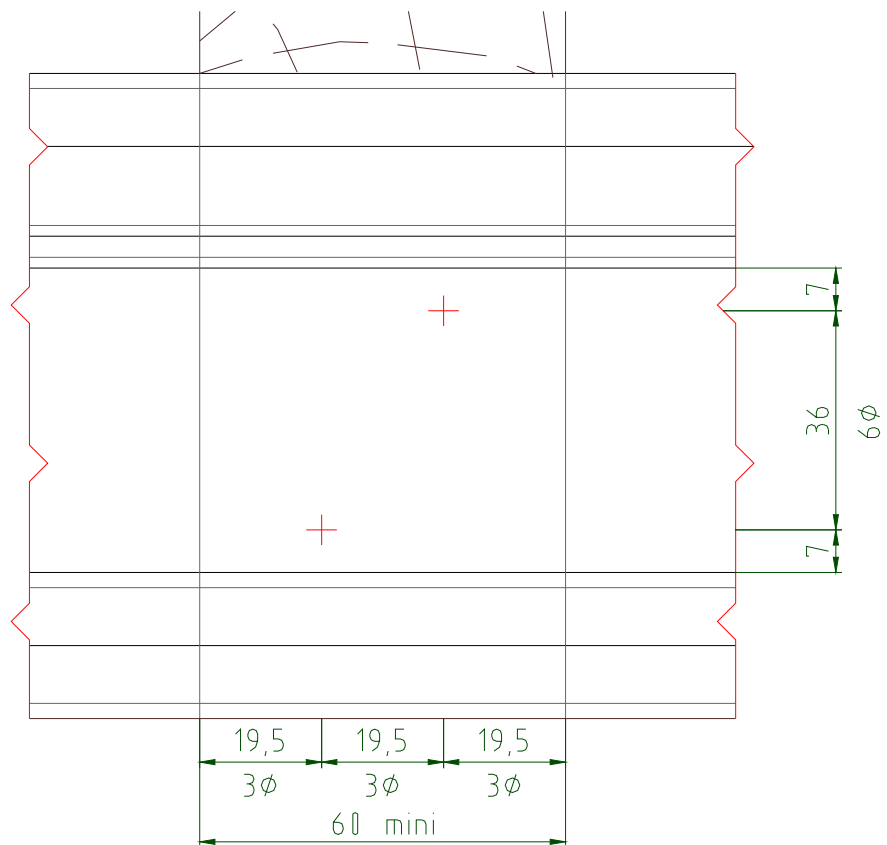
bis – Détail avec 2 fixations en quinconce du rail horizontal sur ossature bois
